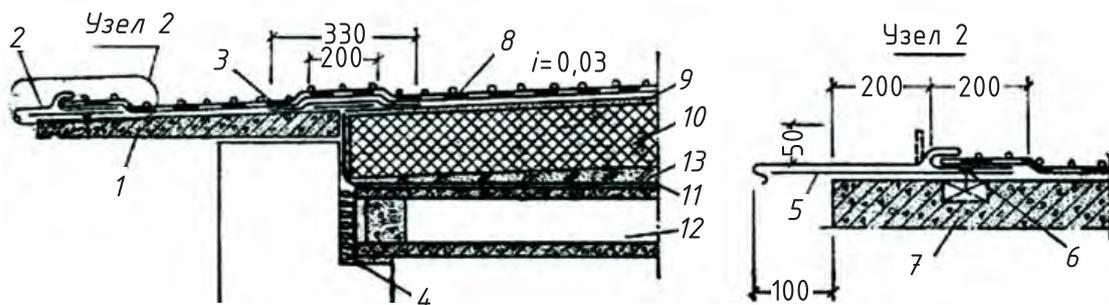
Конструкция невентилируемого бесчердачного совмещенного покрытия с наружным отводом воды: 1 — карнизная плита; 2 — оцинкованный металлический слив; 3 — две дополнительные полосы рубероида; 4 — минераловатный войлок; 5 — кровельный костыль через 600 мм; 6 — оцинкованные гвозди; 7 — деревянная пробка; 8 — гидроизоляционный ковер; 9 — цементная стяжка; 10 — термоизоляция; 11 — пароизоляция; 12 — несущая железобетонная плита с круглыми пустотами; 13 — слои шлакобетона для уклона
